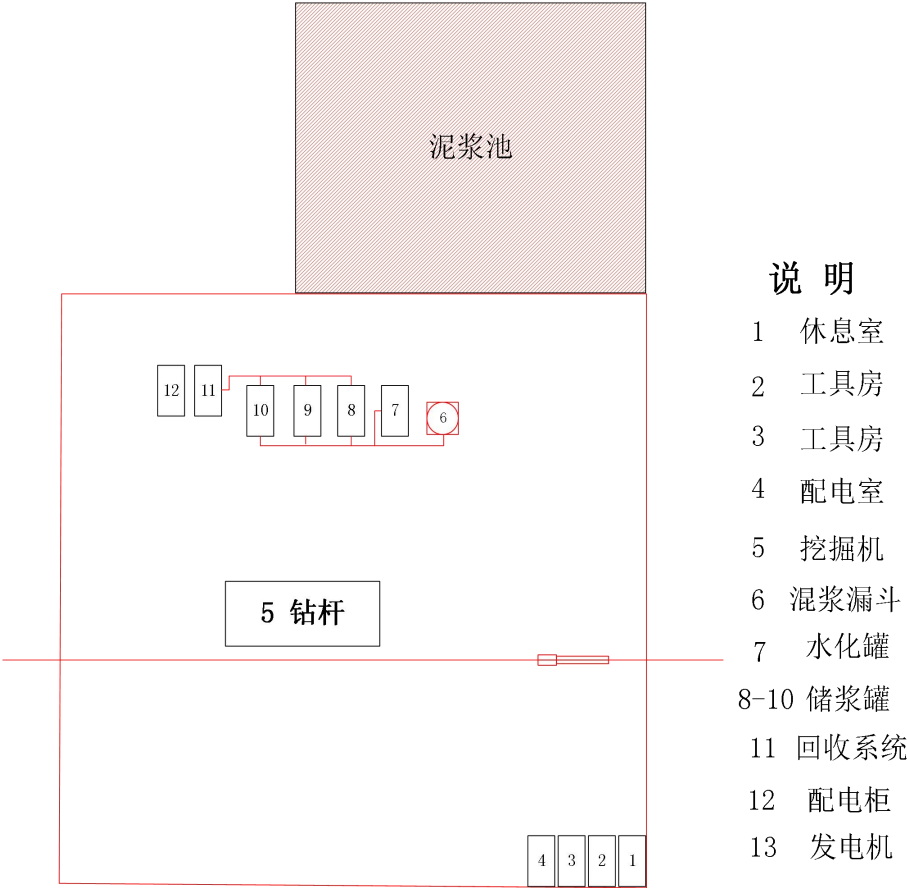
定向钻穿越施工管出土端平面布置示意图
